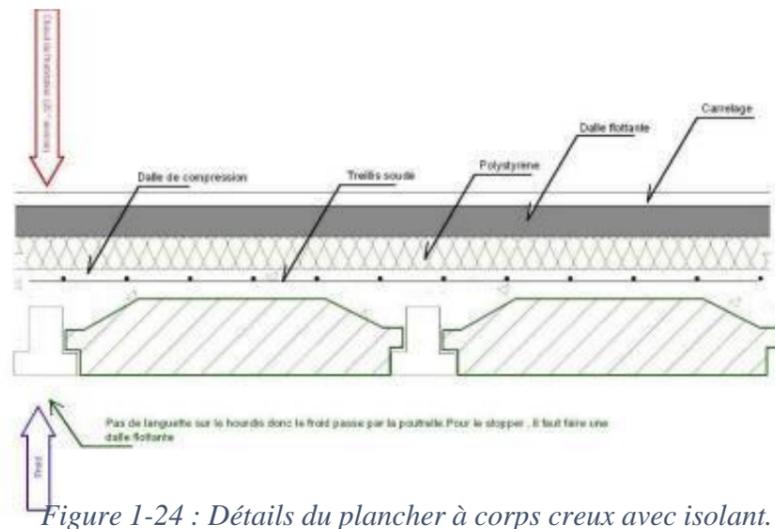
Détails du plancher à corps creux avec isolant.
